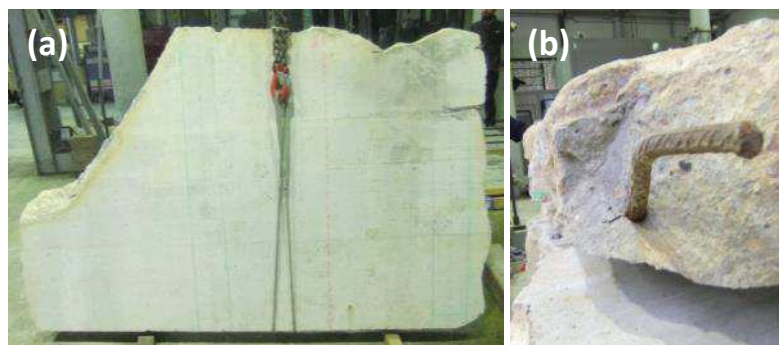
a) Geometría Losa 2C, b) Barra de acero Ø16
